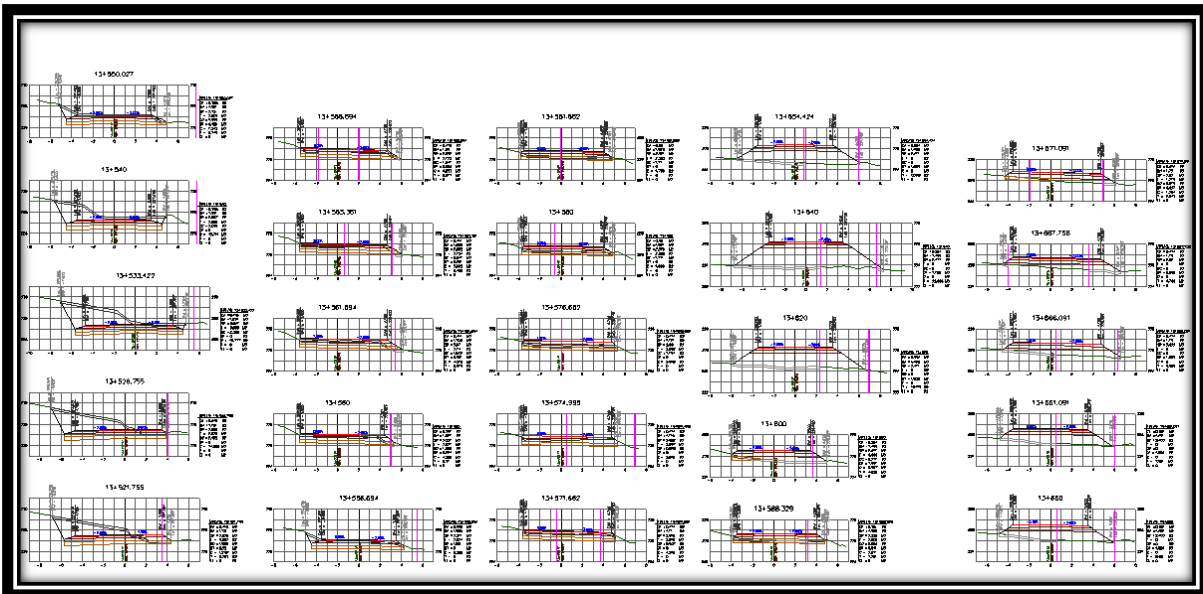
Secciones de construcción del km 13+521.755 al km 13+671.091.
